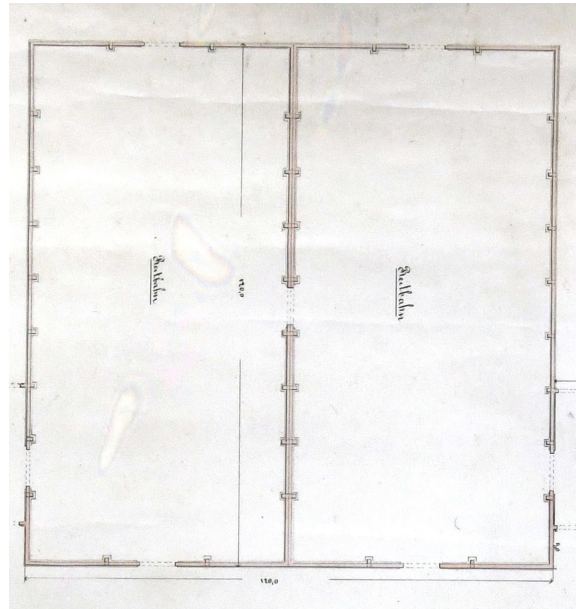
Detail des Grundrisses mit der Doppelreitbahn (Quelle: StATG 2569).
